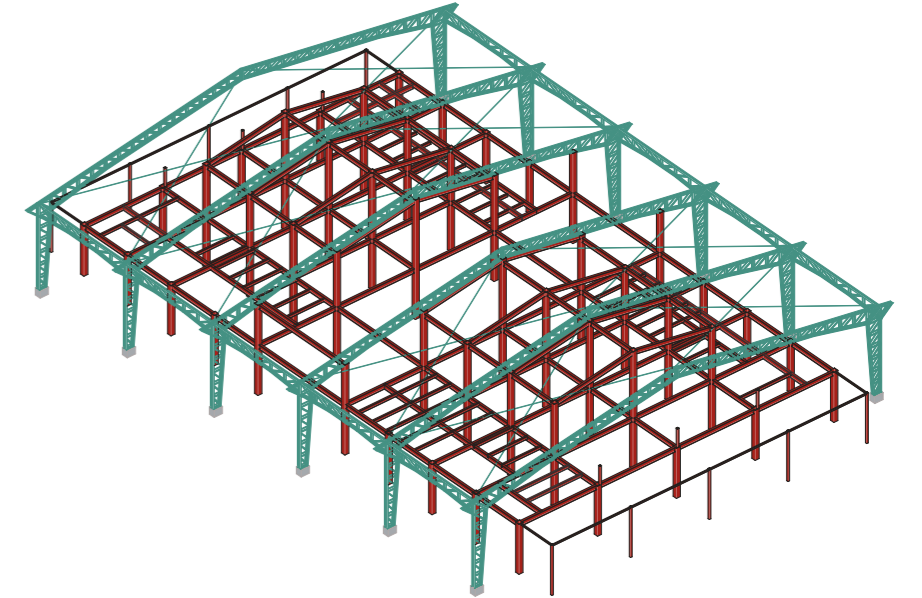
Estructura nueva de la planta de desechos. Fuente: Autoría propia.
